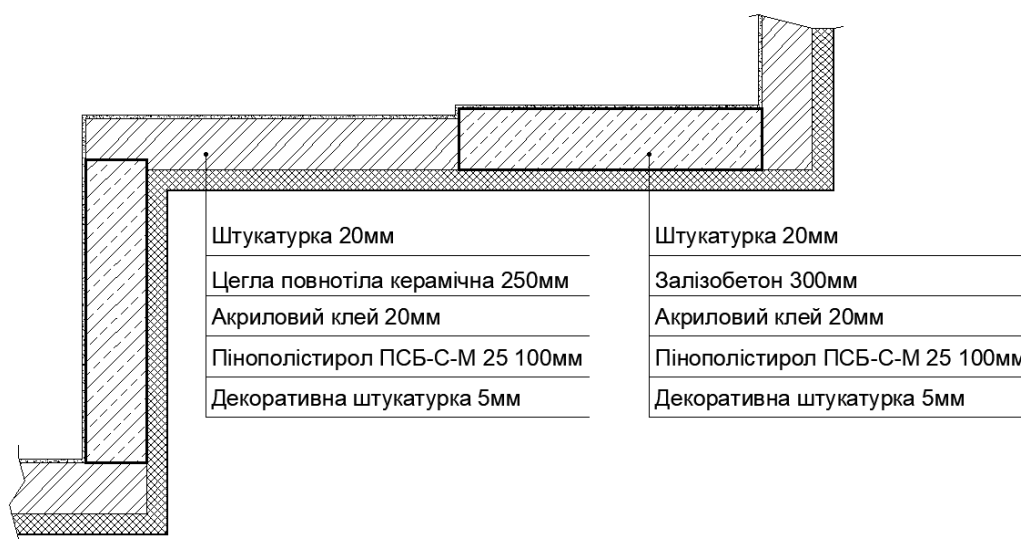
Фрагмент плану зовнішніх стін
